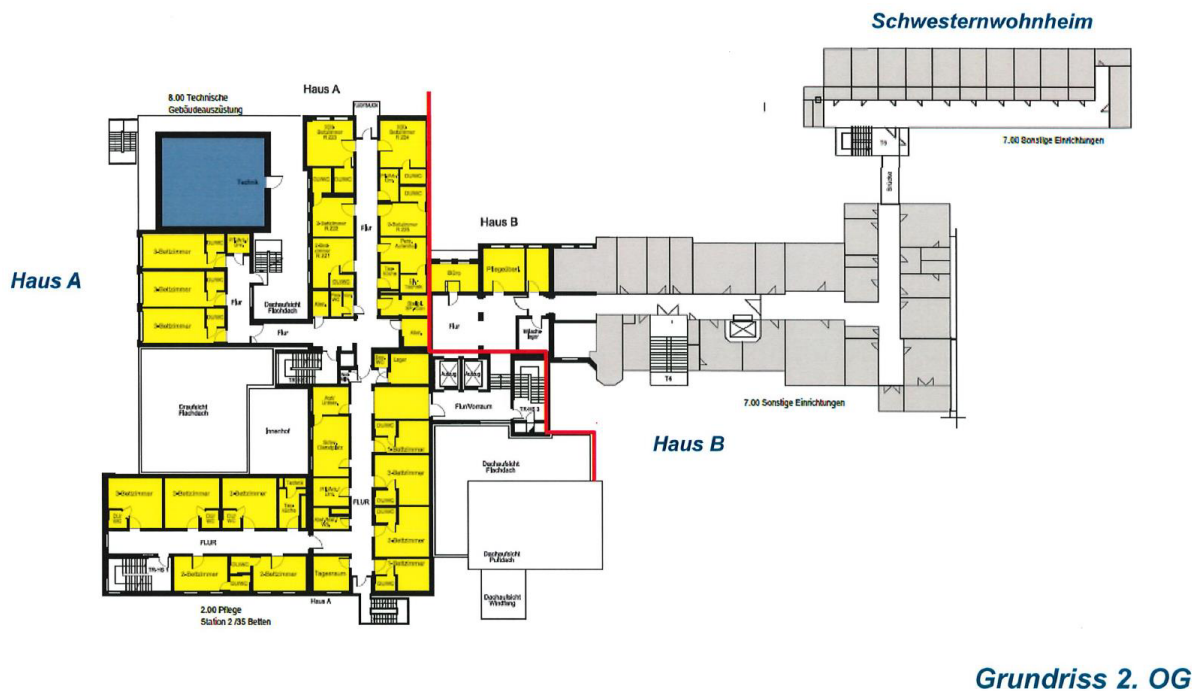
Grundriss zweites Obergeschoss Johanniter-Krankenhaus Gronau
